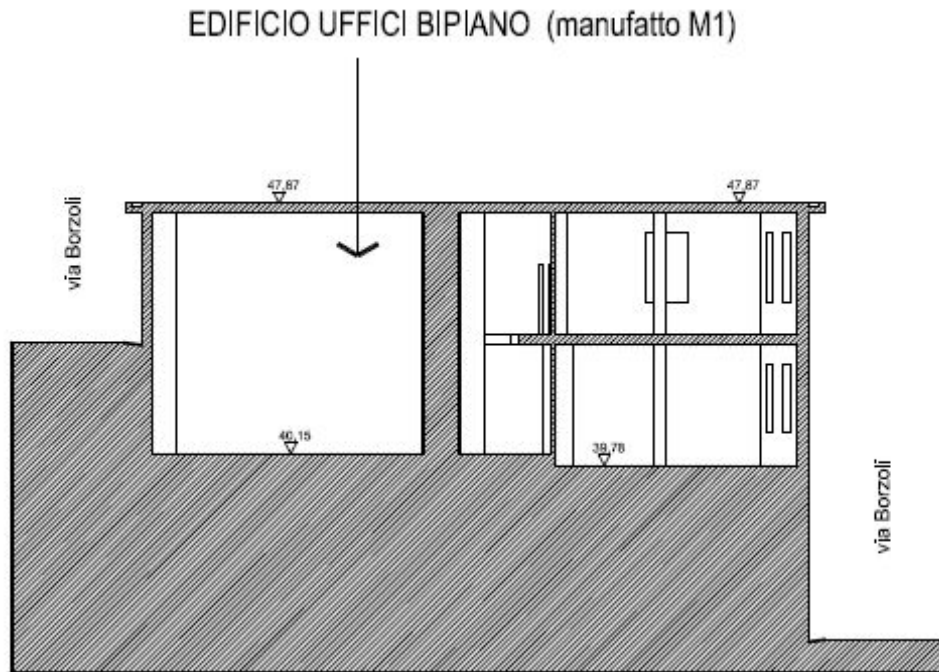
Sezione longitudinale cantiere in fase 2 (edificio M1)
